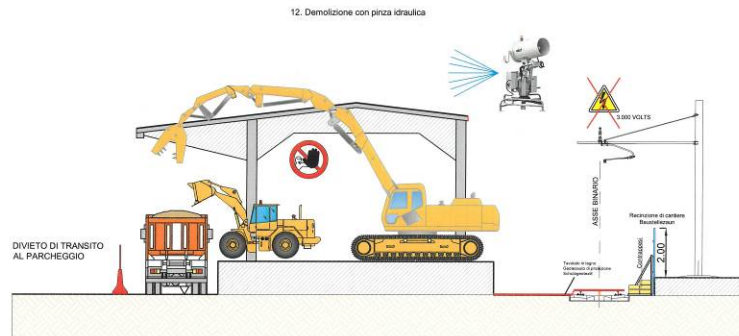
Sezione Demolizione Edificio A9 – Demolizione con pinza idraulica
